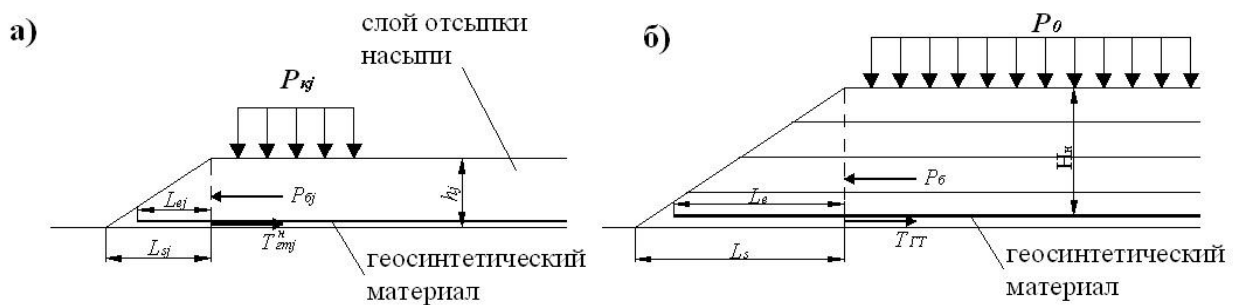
Схема к расчету устойчивости армированной насыпи по плоским поверхностям скольжения: а) при отсыпке первого слоя насыпи; б) по завершению отсыпки насыпи
